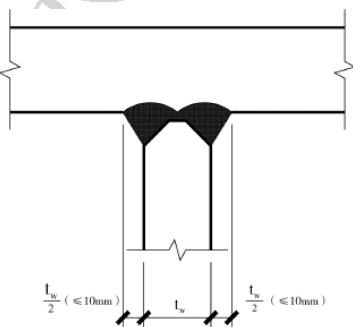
焊透的 T 形连接对接与角接组合焊缝
